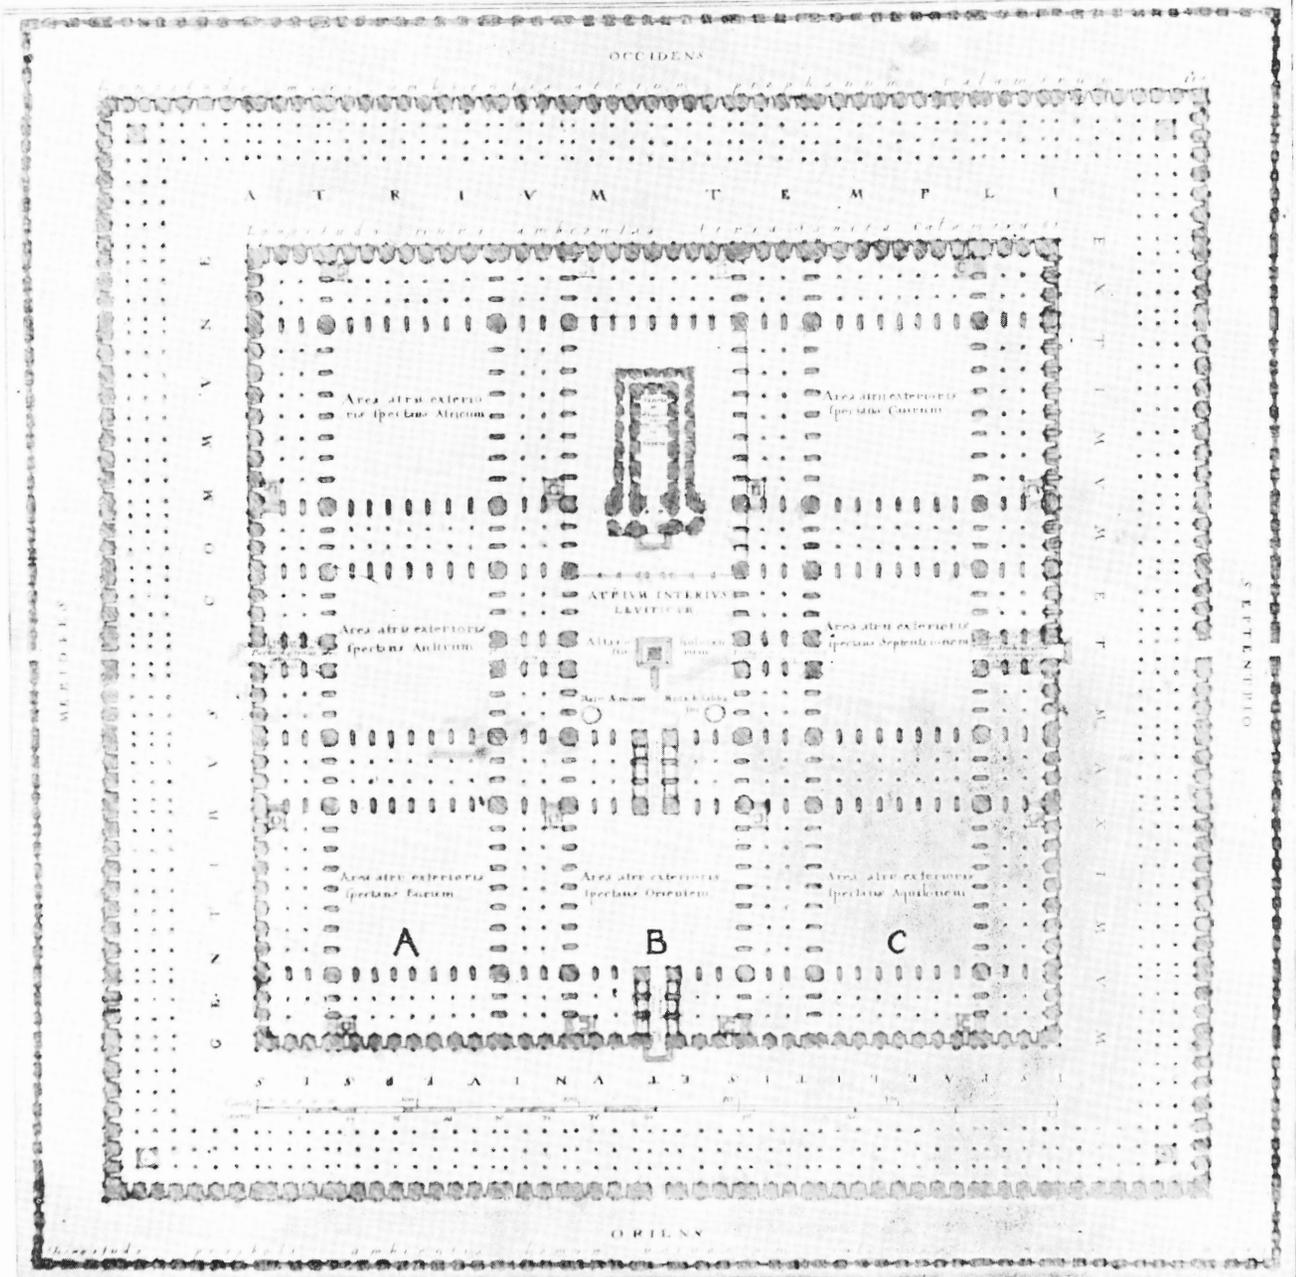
VILLALPANDO: Planta del templo de Salomón.
